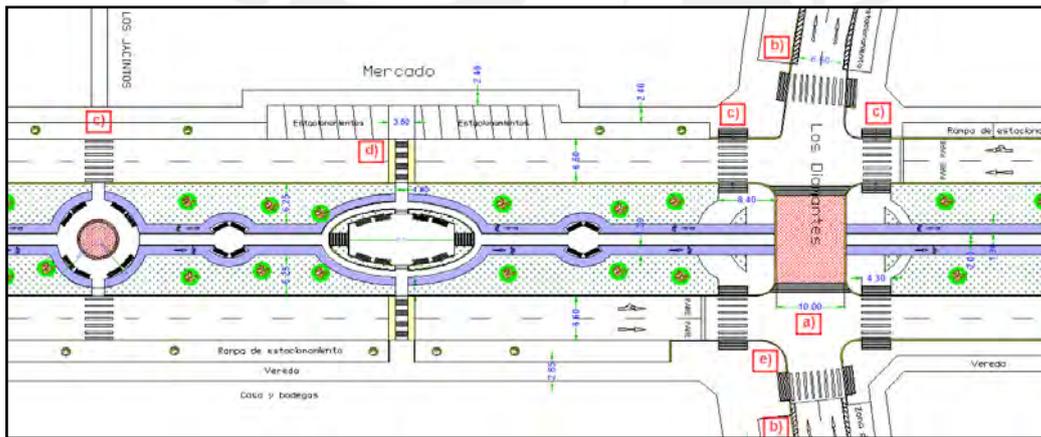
Situación propuesta Vista en Planta de la Calle Palermo.
